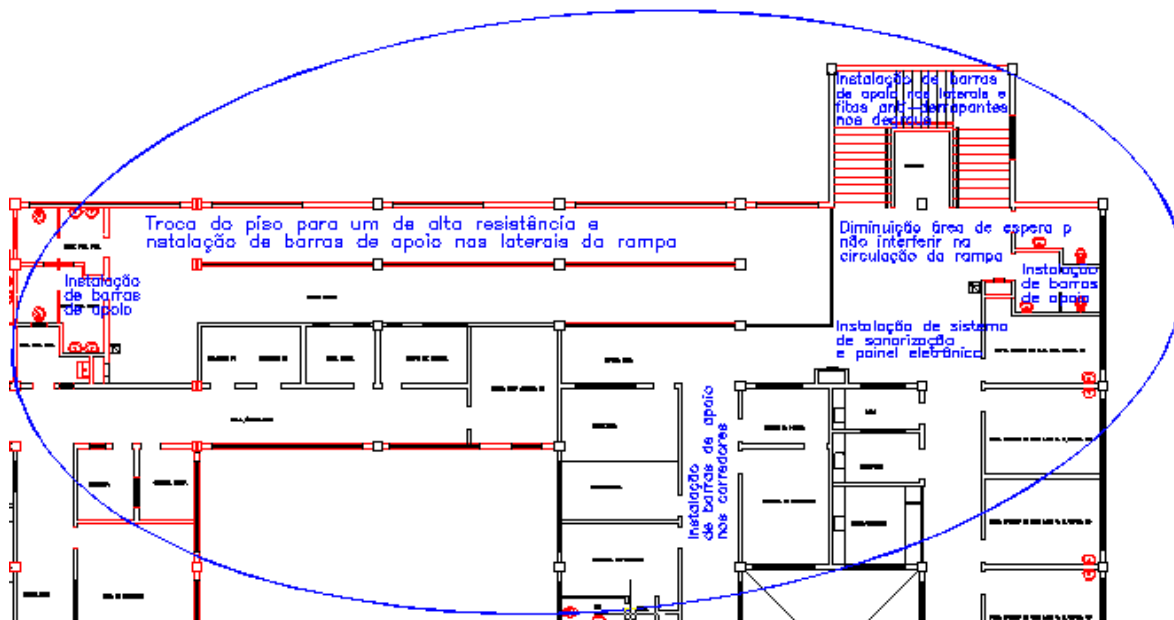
Planta baixa do pavimento térreo do atendimento ambulatorial, alterações propostas.. Fonte: Cedido pelo HUPES. Alterações da autora
